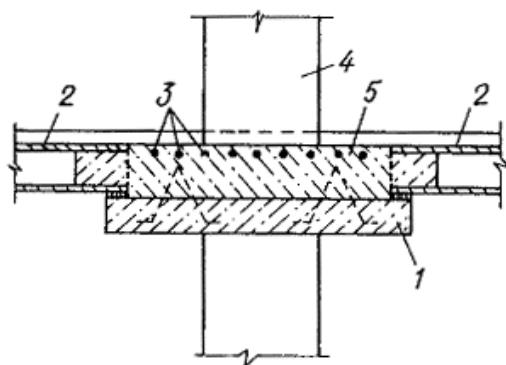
Схема соединения плитного ригеля и плит перекрытия (США)
